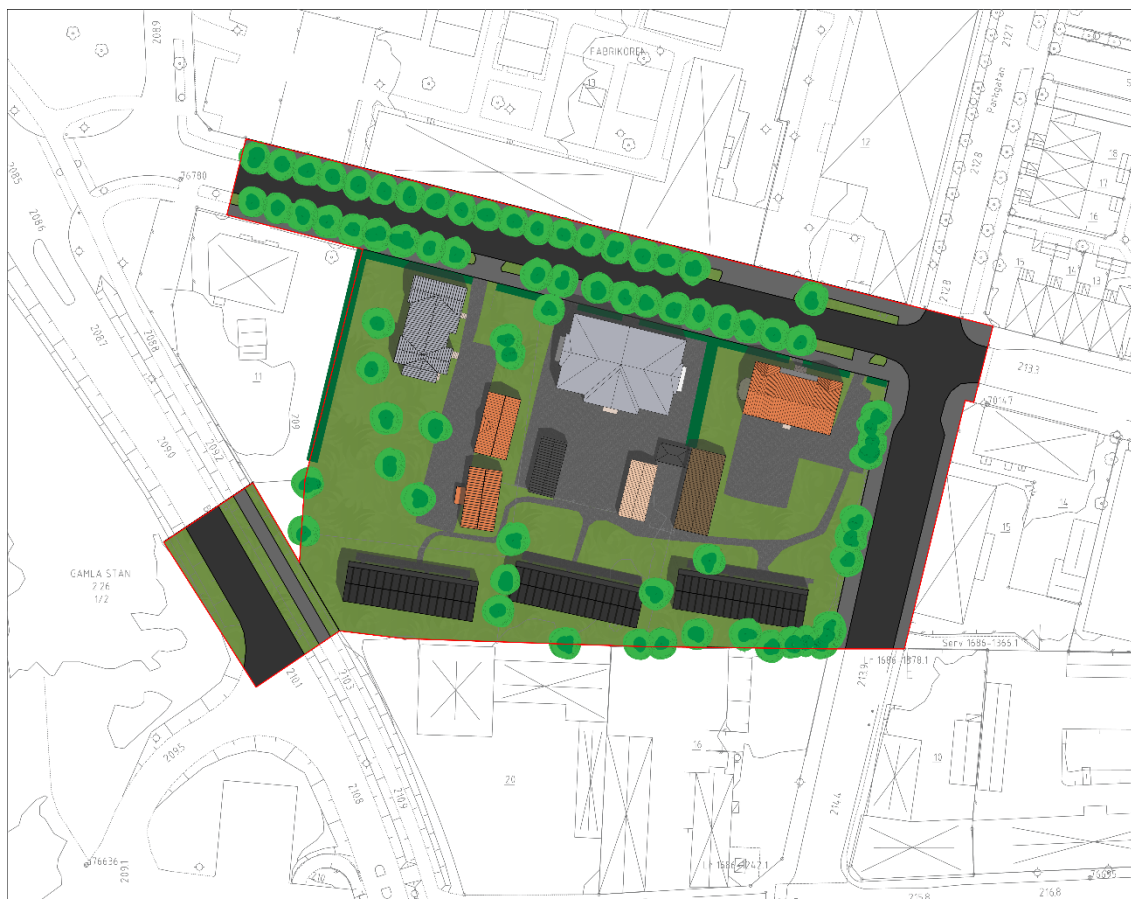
illustrerar ett möjligt genomförande av planförslaget
